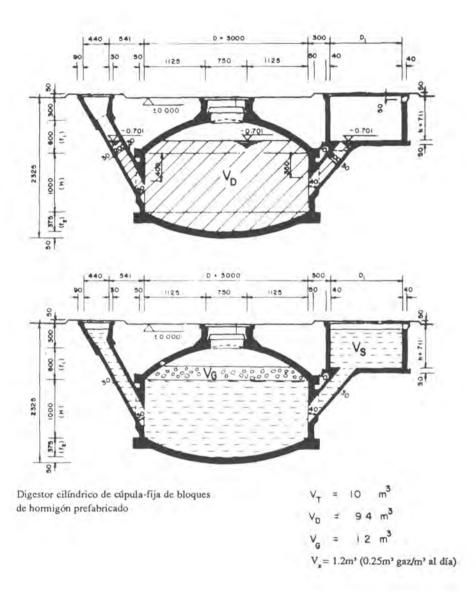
Digestor cilíndrico de cúpula fija construído con bloques de hormigón prefabricado. (Véase ref. 14)
